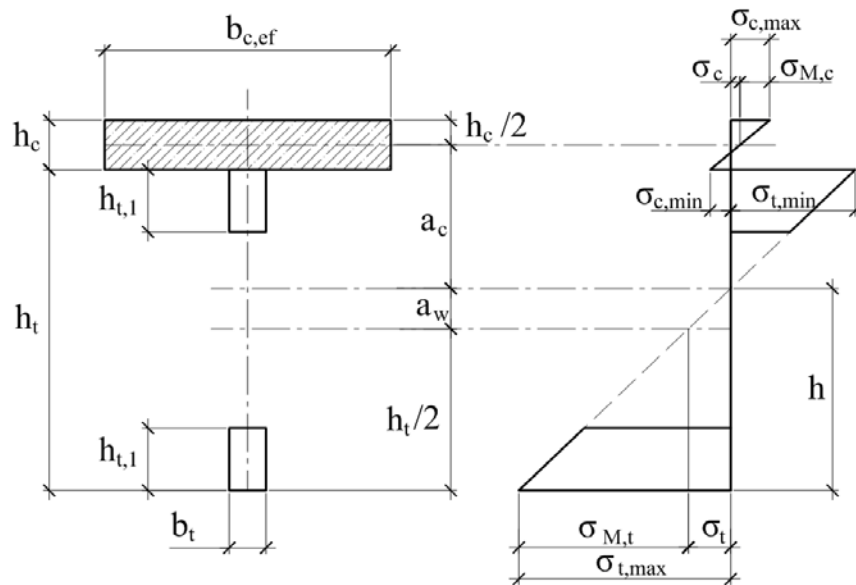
Поперечний переріз елемента і розподіл напружень в поперечному перерізі деревогрунтобетонного перекриття по дерев'яним фермам при розрахунку за γ -методом
